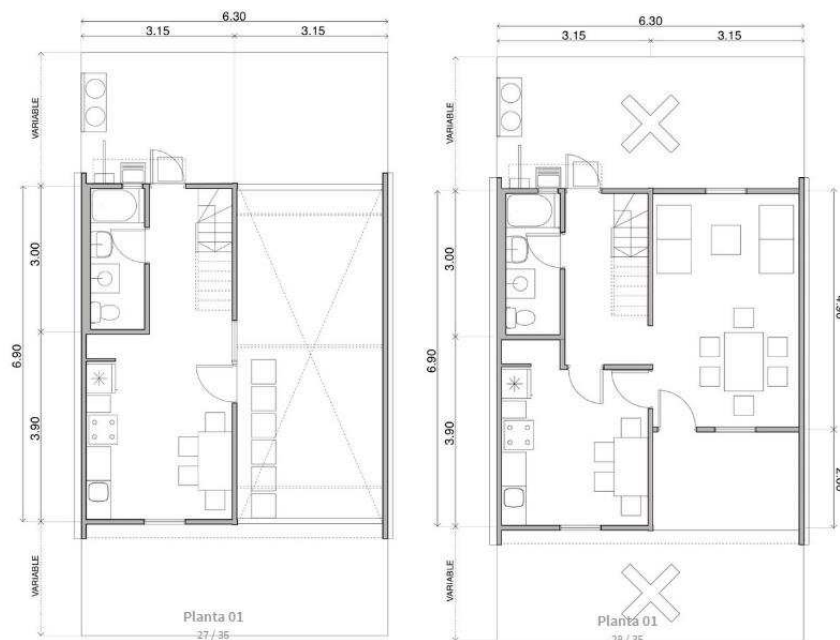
Proyecto de vivienda de interés social progresiva “Villa Verde” – Planta arquitectónica Baja
